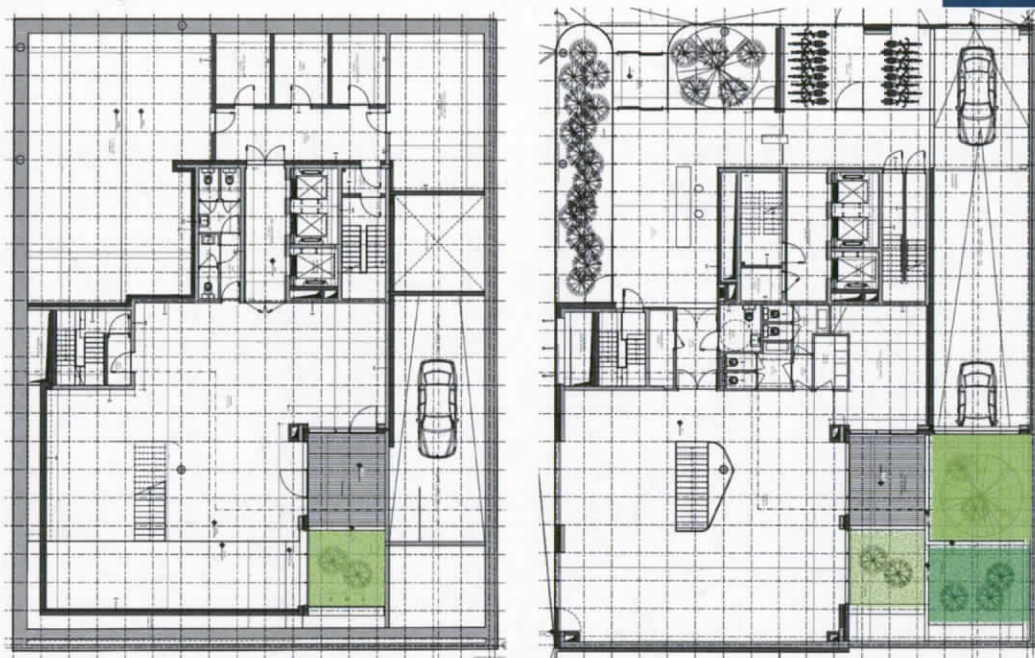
Zones de cours et jardins _ Plan du rez de jardin et plan du rez-de-chaussée
